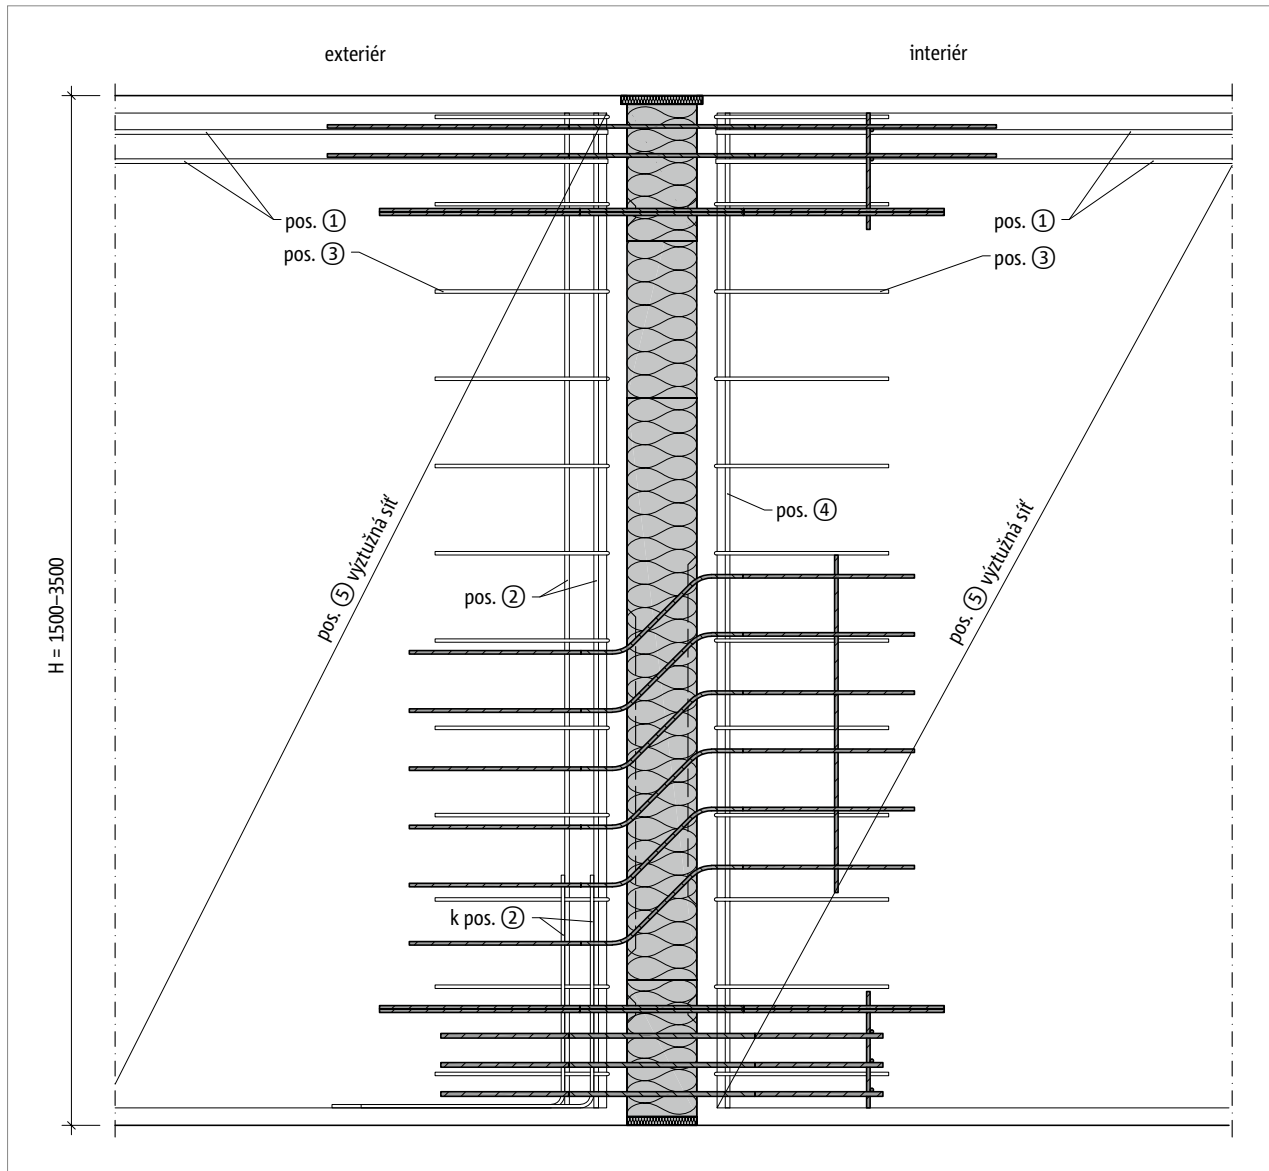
Schöck Isokorb® XT typ WL-M4: Půdorys prvku
